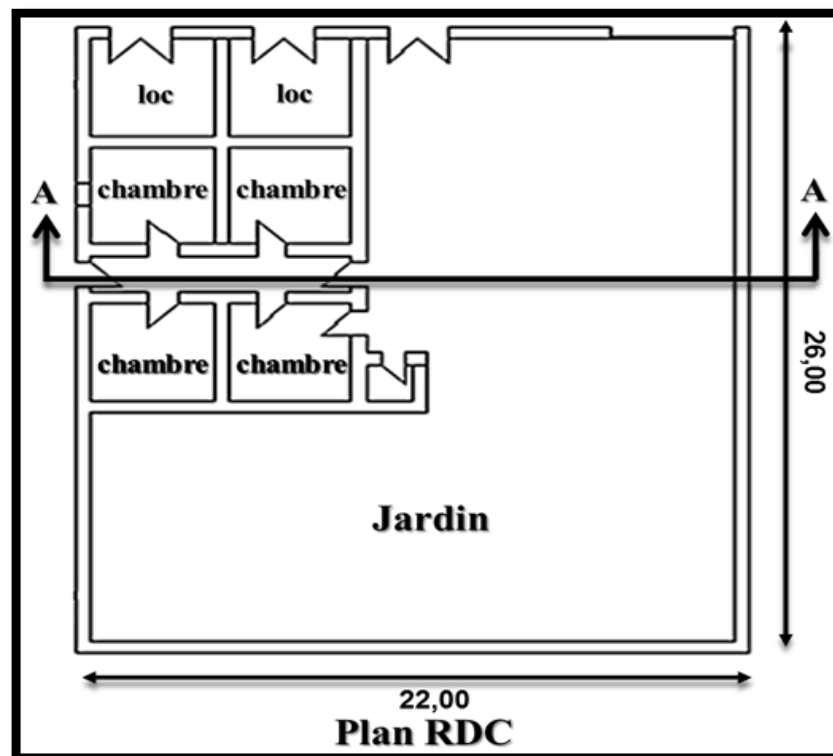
plan de 3<sup>ème</sup> maison a cour
